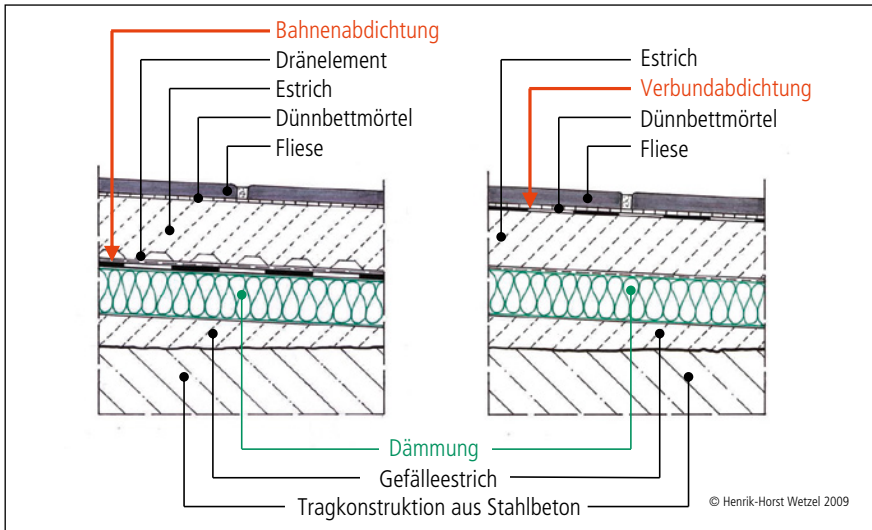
■ Bodenaufbauten mit bahnenförmiger Abdichtung und Verbundabdichtung [40]
